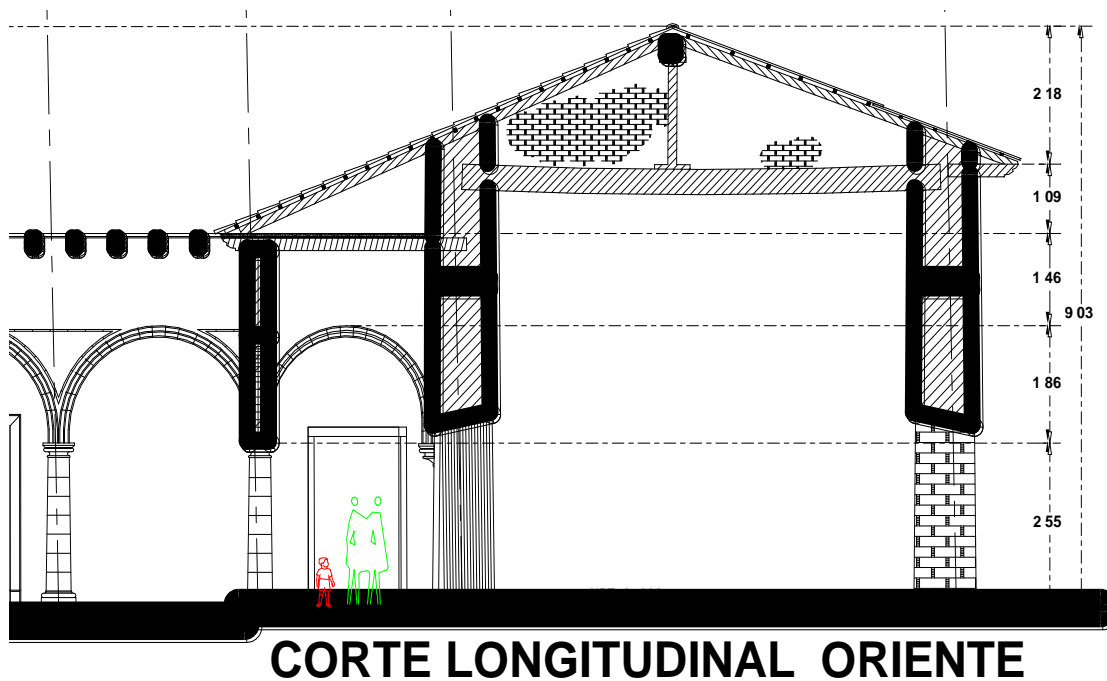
Detalle constructivo de la cubierta inclinada a dos aguas del área correspondiente al granero.
